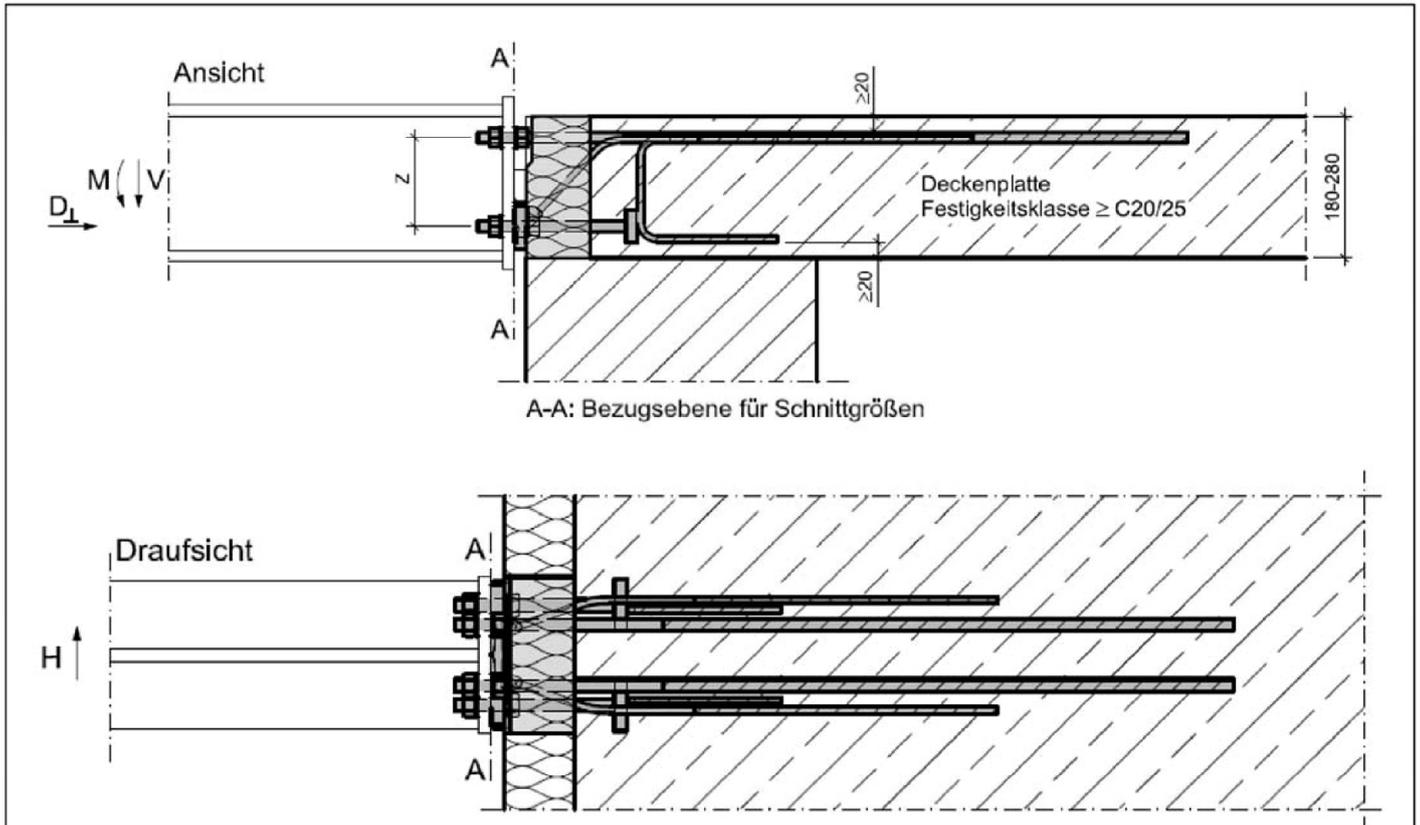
und 54: Schöck Isokorb® T Typ SK-M1-V1 und T Typ SK-M1-V2, Schnittgrößendefinition
